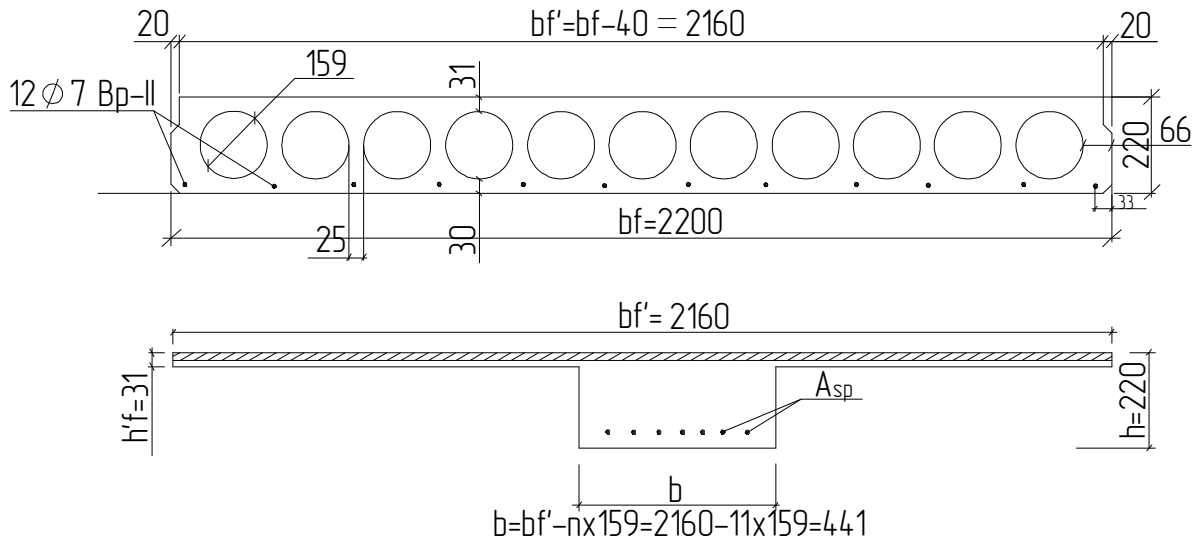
Поперечное сечение плиты с круглыми пустотами
